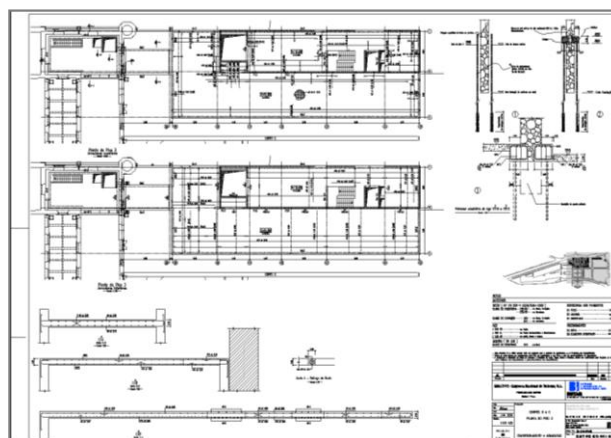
Pormenorização de armaduras de uma laje do Corpo C. Pormenor construtivo para a execução da abertura de vão na ligação à cave, executada sob o palacete
